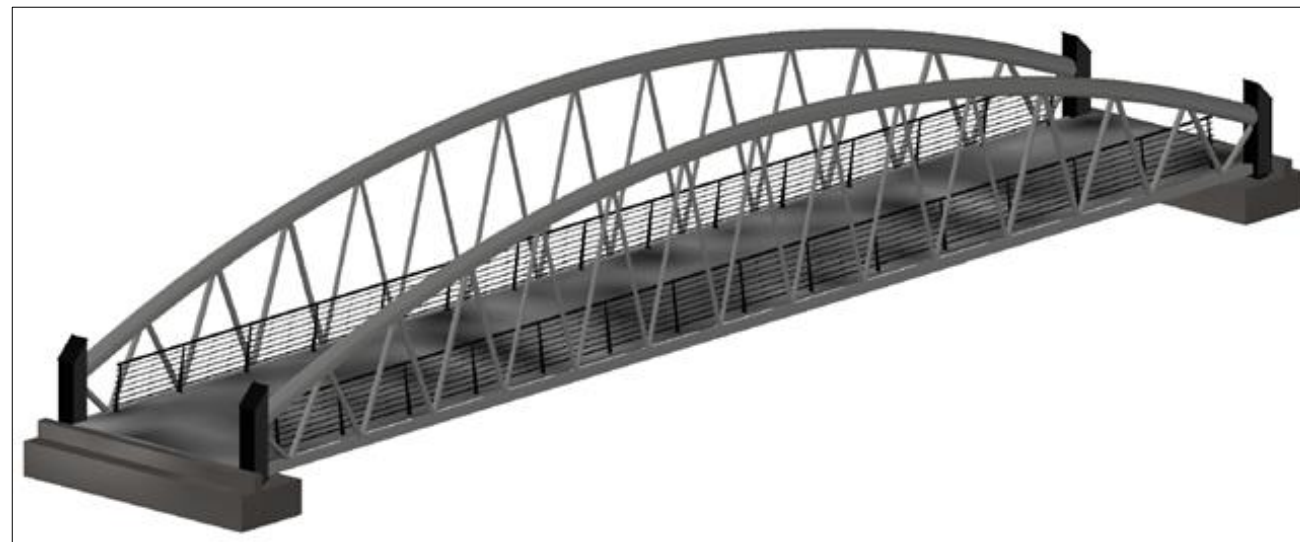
Vista longitudinal modelo Sap2000, vista con las placas de hormigón (Fuente: elaboración propia)
